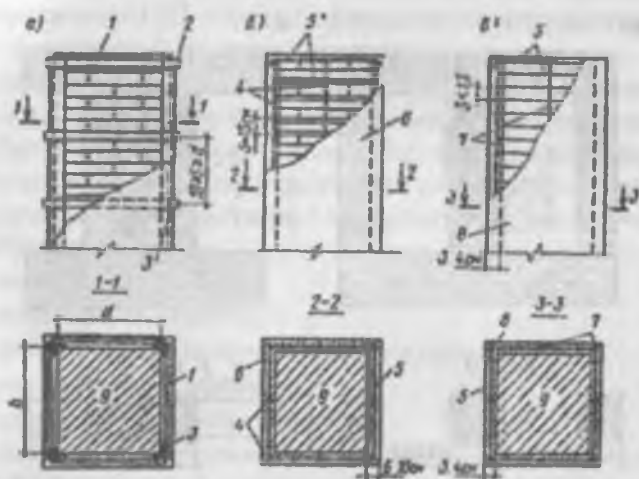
Усиление каменных столбов стальной (а), железобетонной (б) и армированной растворной (в) обоймами:
